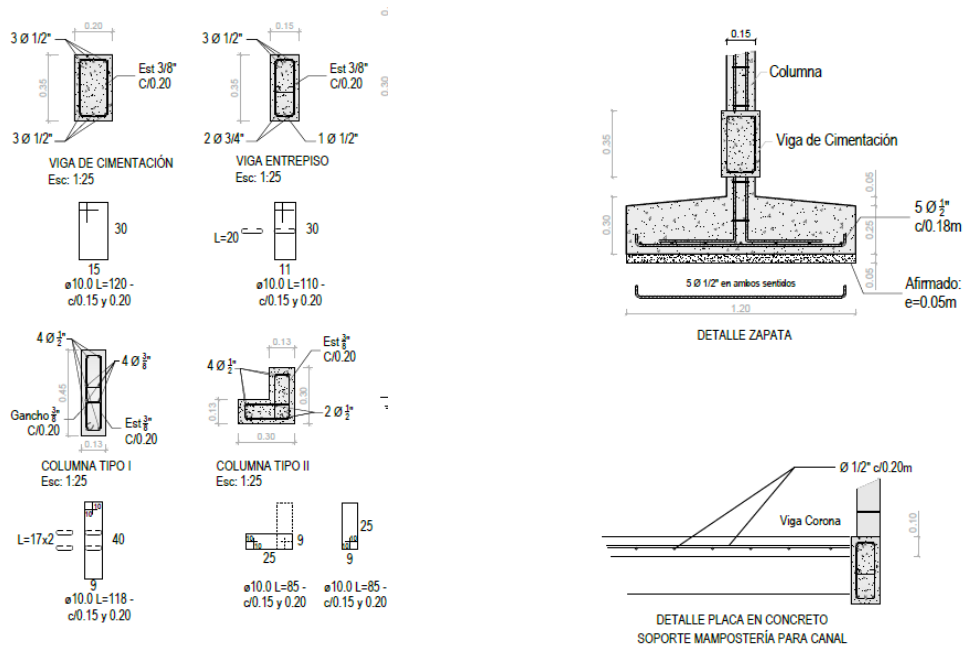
Detalles Estructurales Actual Cafamaz.
